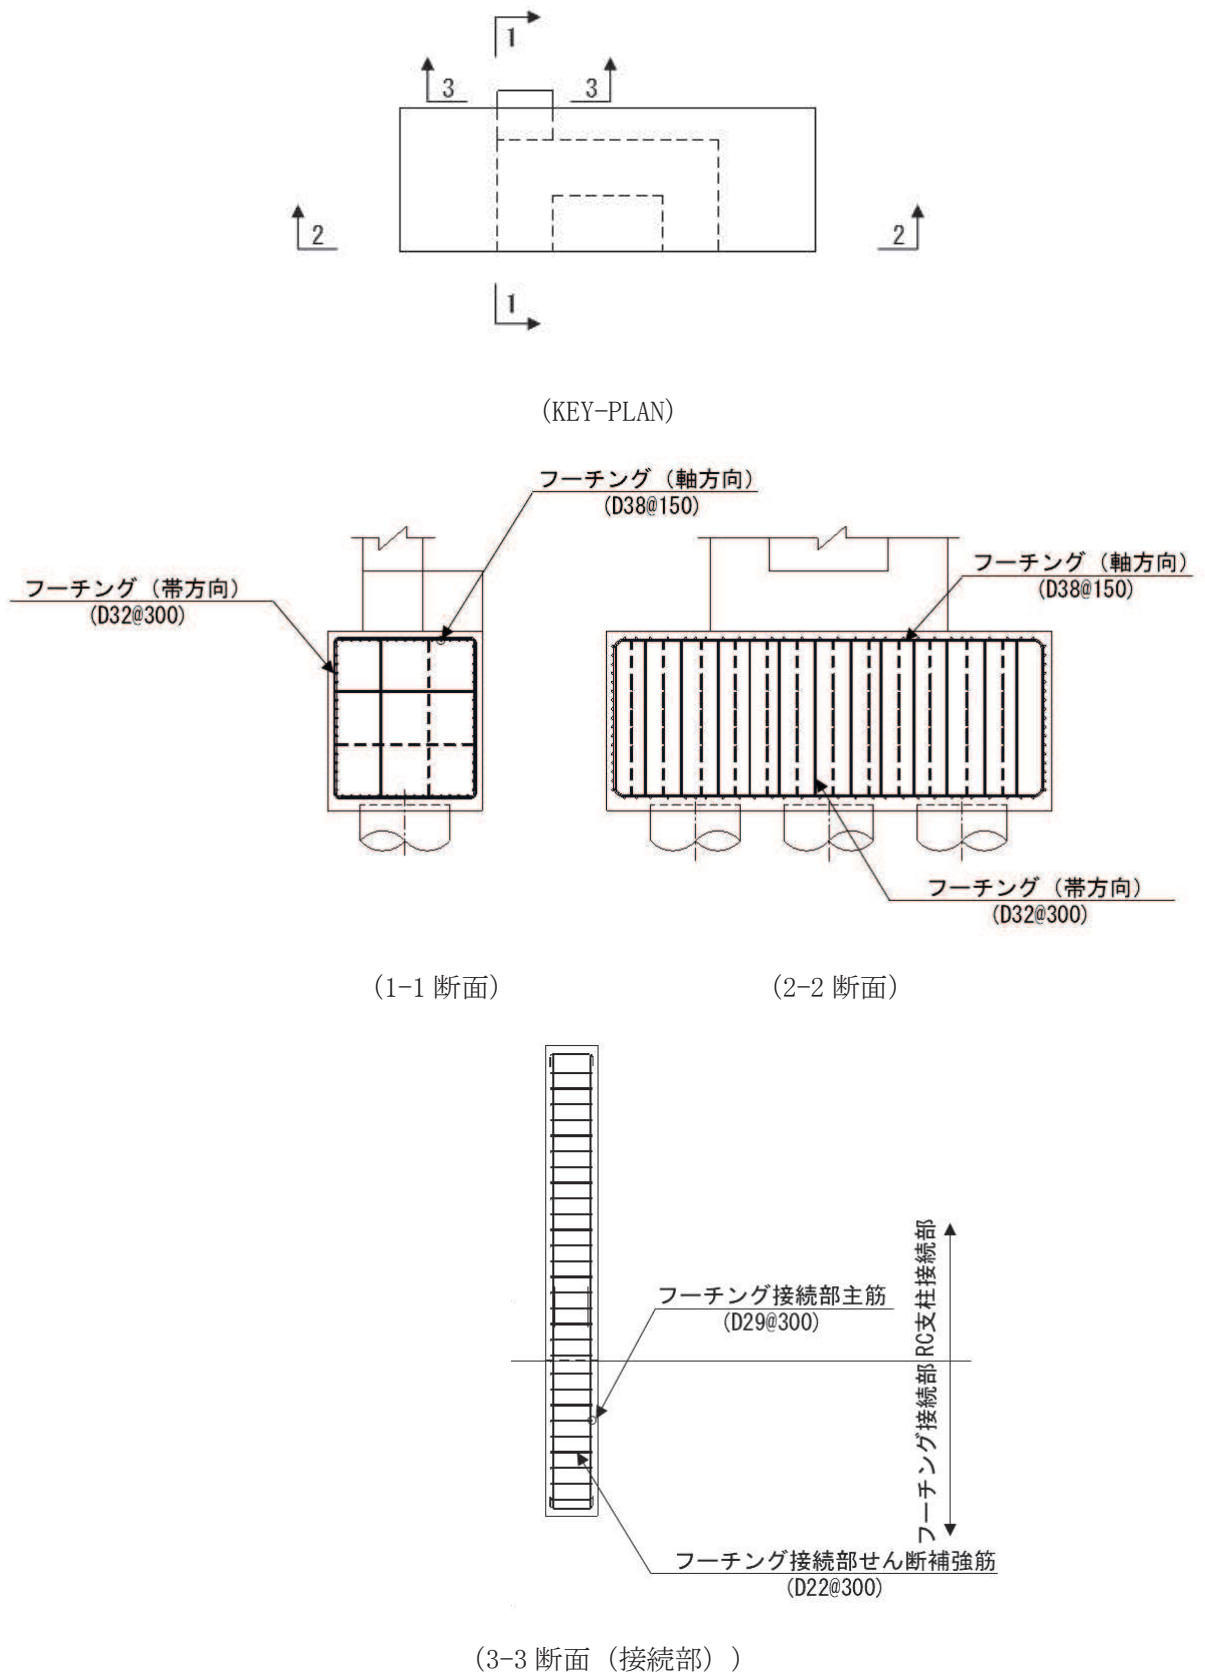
鋼製遮水壁（鋼桁）のフーチング配筋概要図
